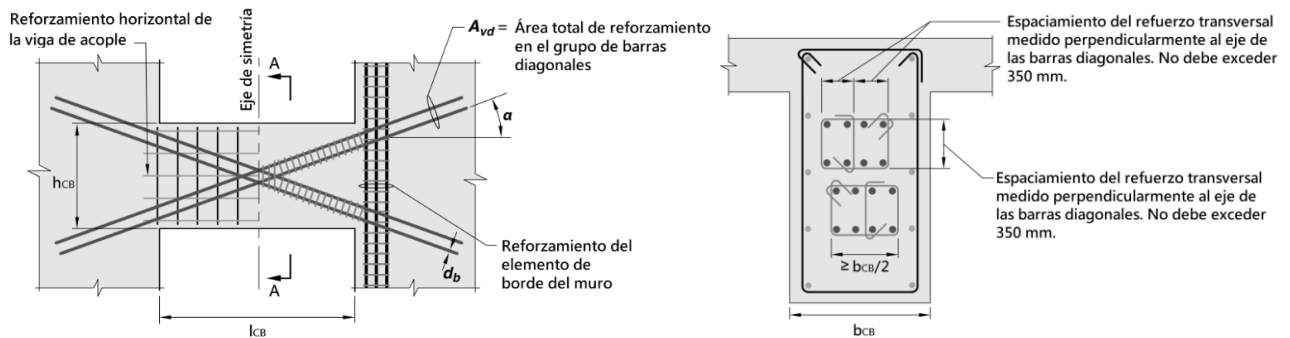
Vista en elevación y corte transversal del refuerzo orientado en diagonal en una viga de acople.
